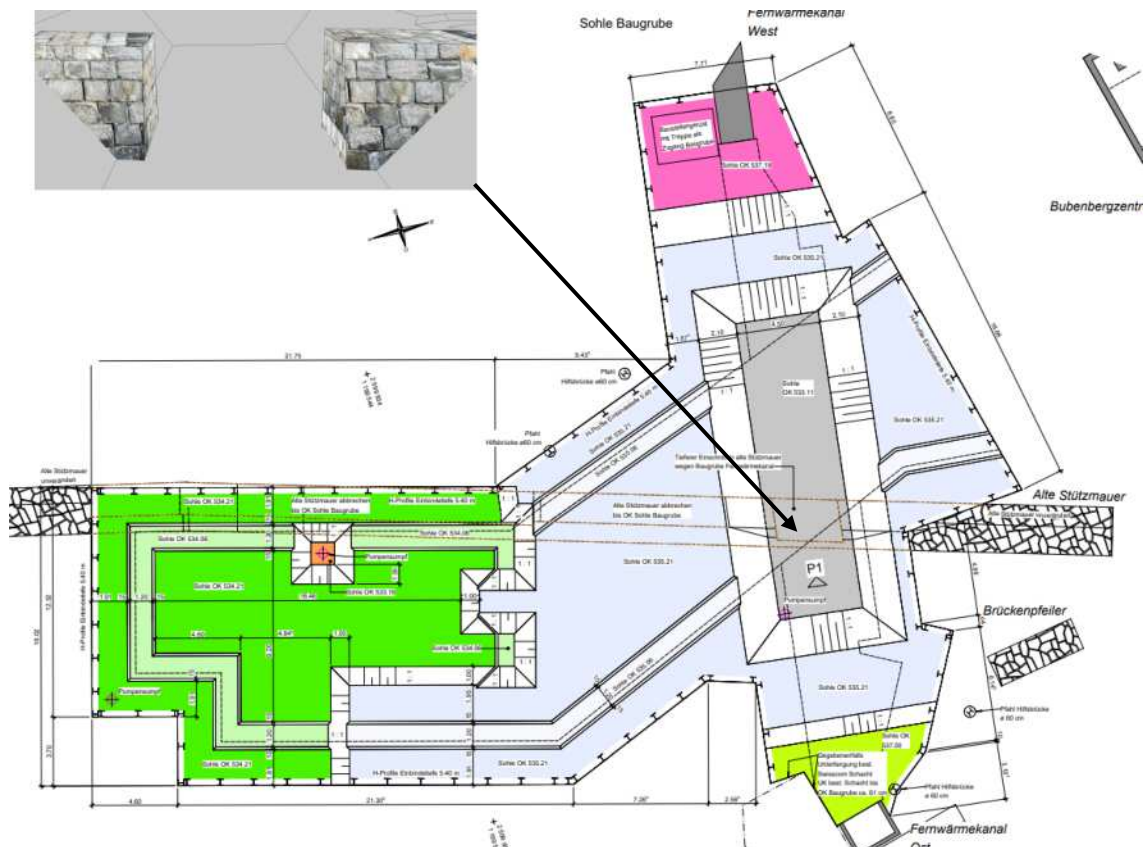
Plan Unterführung Hirschengraben mit Einschnitt in historische Mauer (Plan Nr. 2-60, 05.04.2023)
